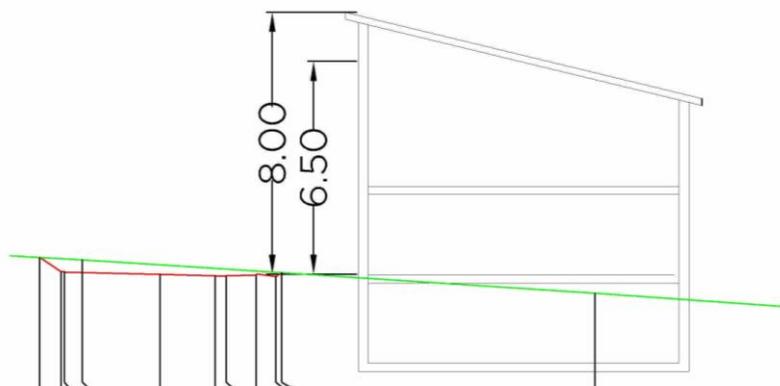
Systemschnitt zur Definition des Bezugspunktes für Pultdach
